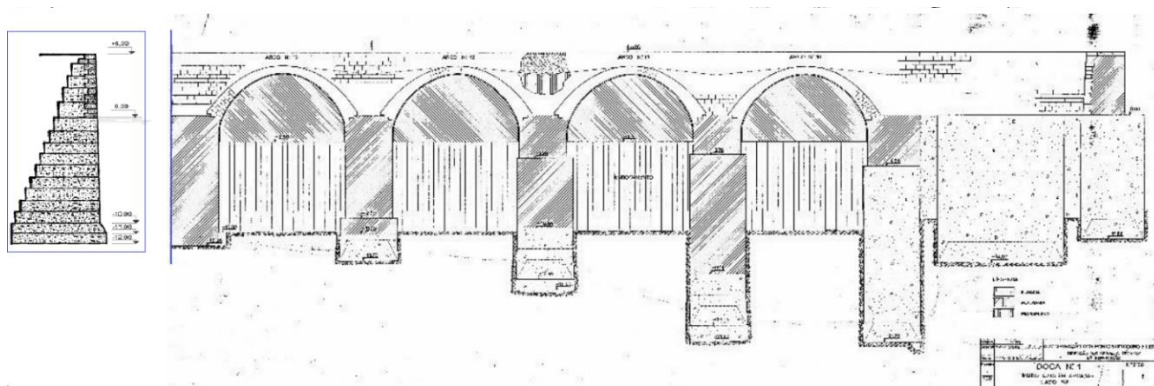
Perfil e Muros Cais em Arcadas da Doca nº1 – Fonte: Adaptado APDL, 2015
